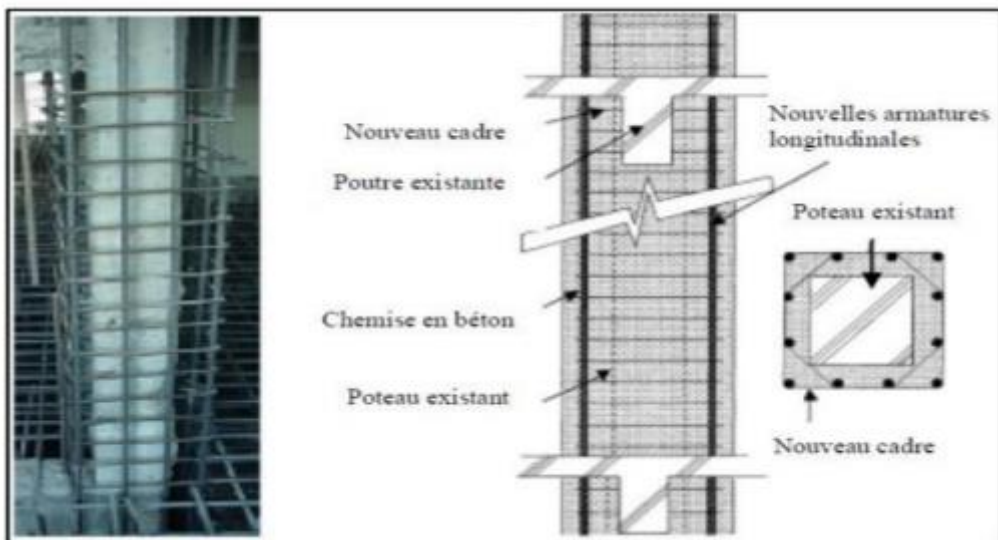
Chemisage en béton armé d'un poteau [24]
